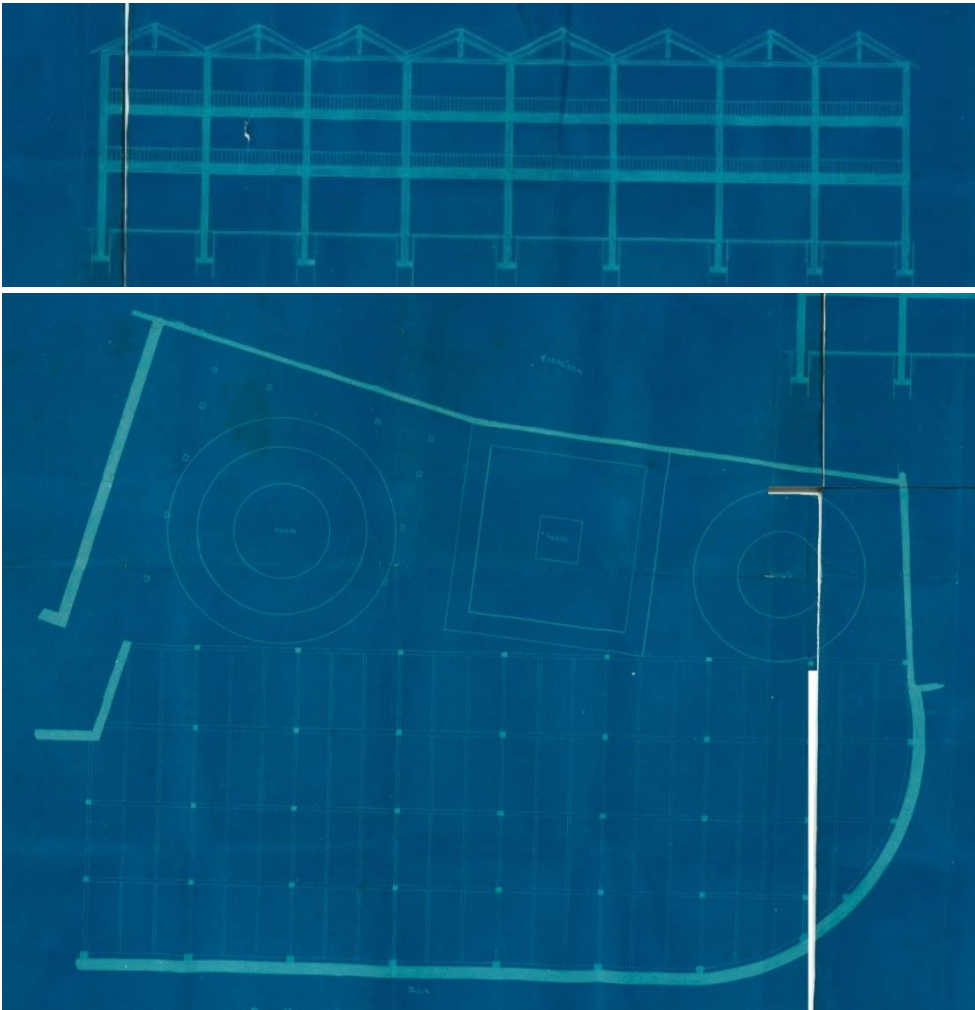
Alzado y planta del proyecto de construcción de secadero de Astiazaran. 1925. (AMO 1925)
